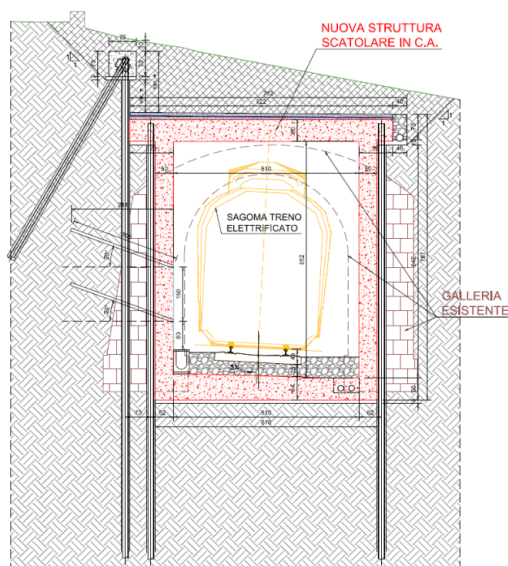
Nuova sezione gallerie *Sanzan 1* e *Sanzan 2
